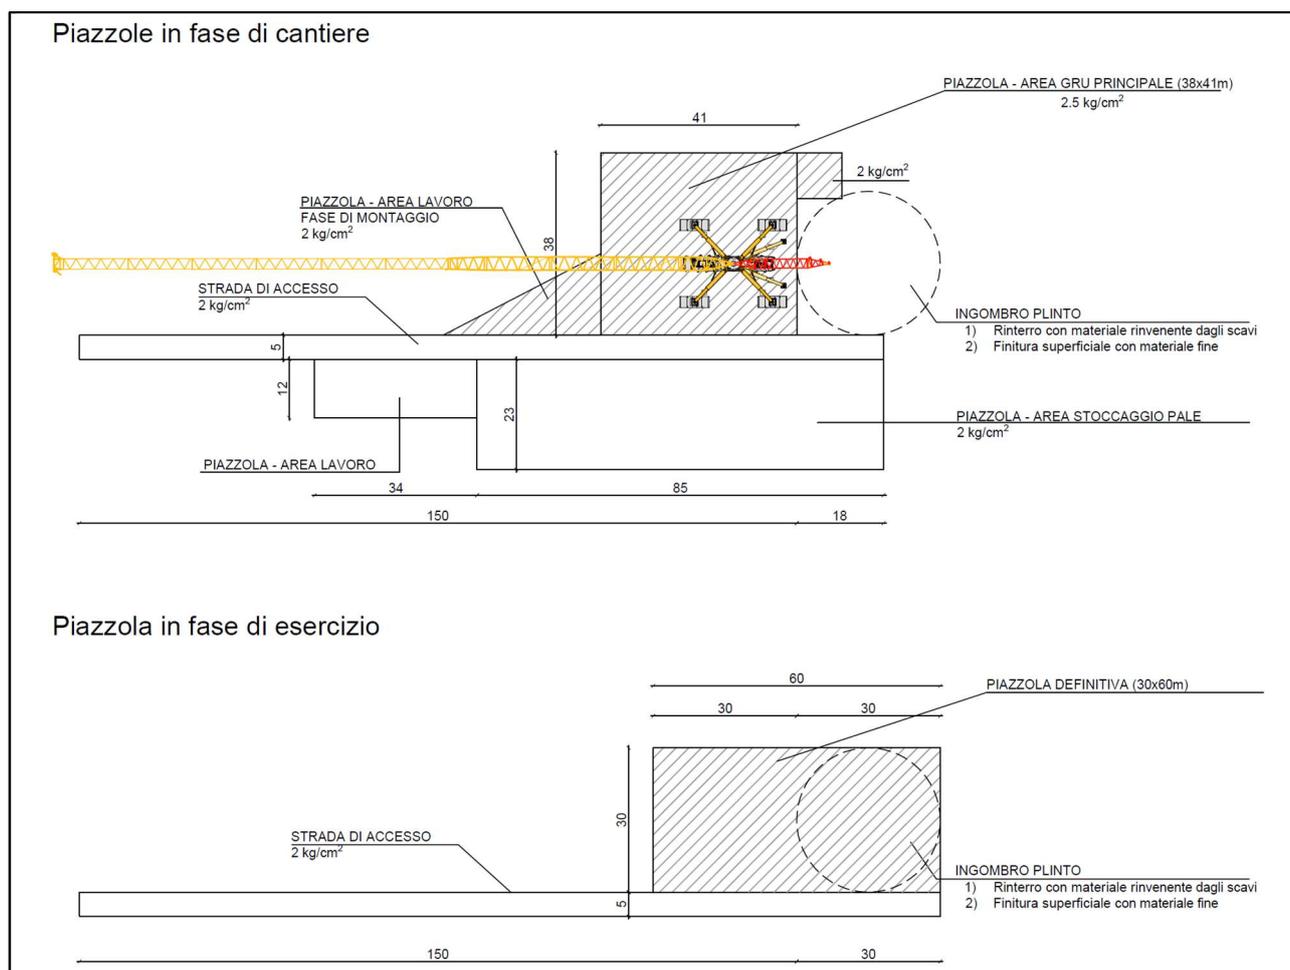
Planimetria piazzola tipo per la fase di installazione e fase di esercizio e manutenzione
